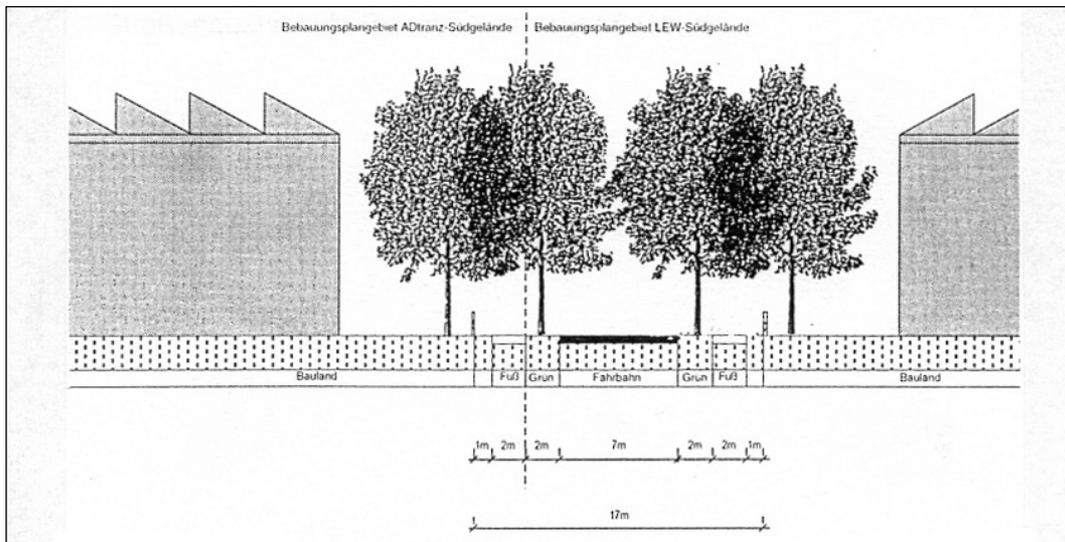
Straßenquerschnitt Walter-Kleinow-Ring
